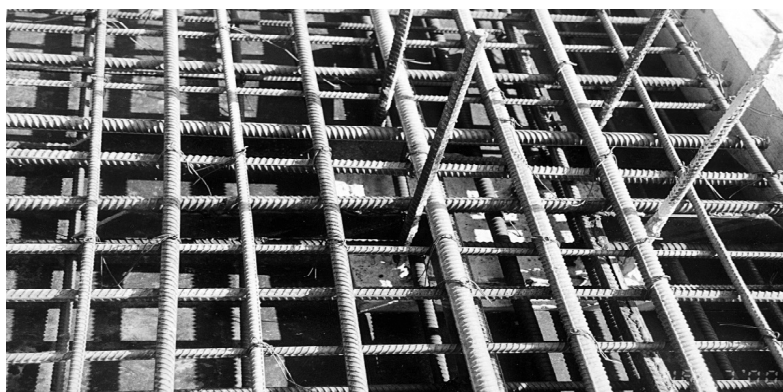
Опытный фрагмент (ОФ) армирования плиты металлическими вставками
